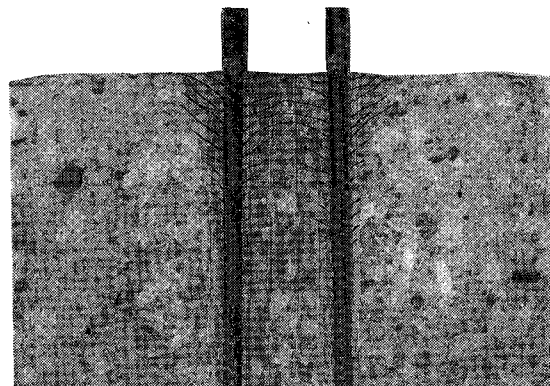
内部ひびわれ発生状況 (鉄筋 1 本, D22)
